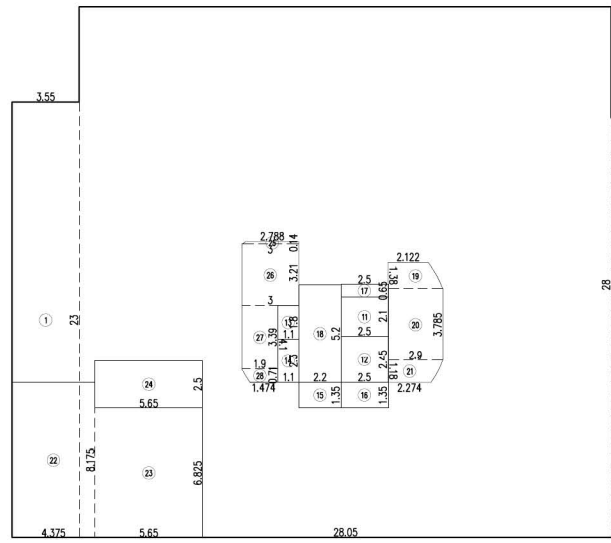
屋突三層平面圖 (比例尺 1/200)
